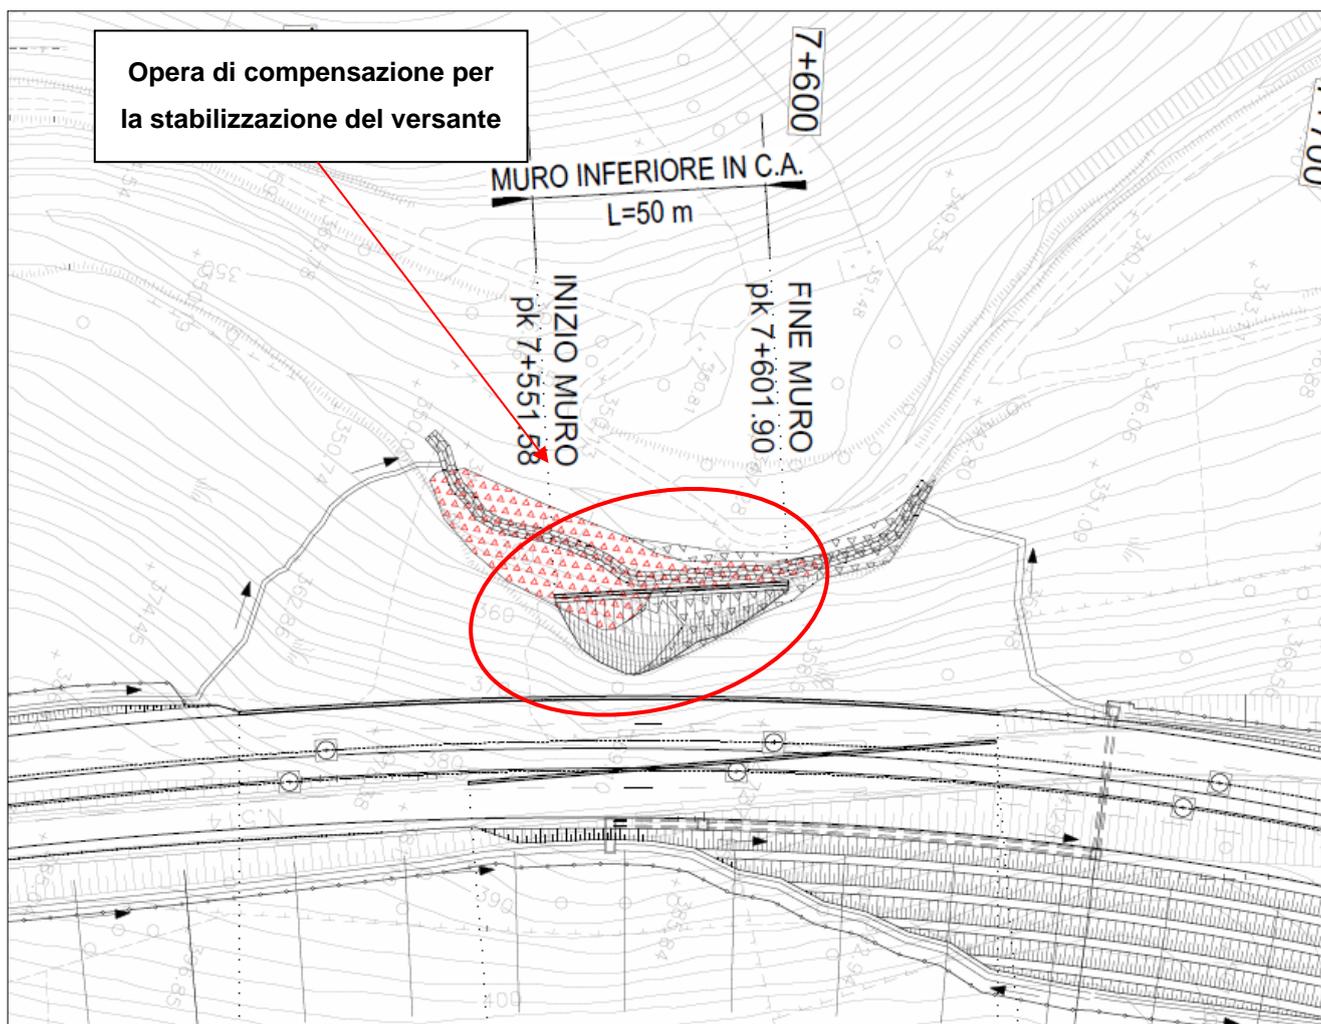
Lotto 1- Stralcio planimetrico dell'intervento previsto su frana
